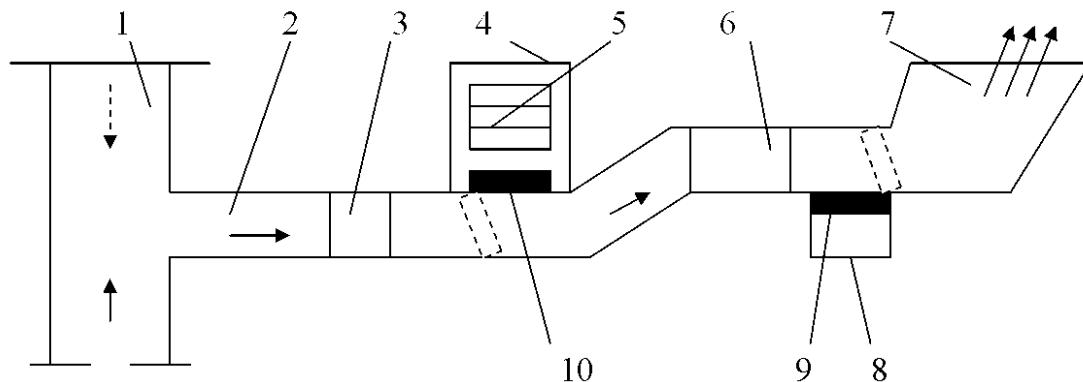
Спрощена схема вентиляторної установки з осьовими вентиляторами:
